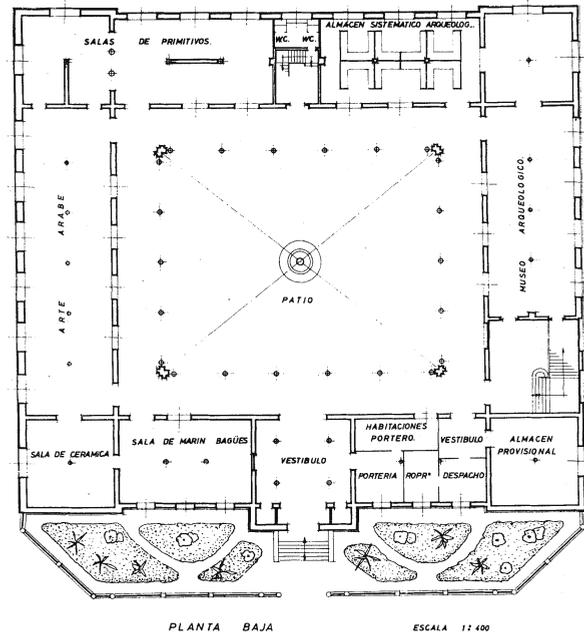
Museo de Zaragoza. Distribución de espacios en el año 1954. Planta baja. (AMZ).
